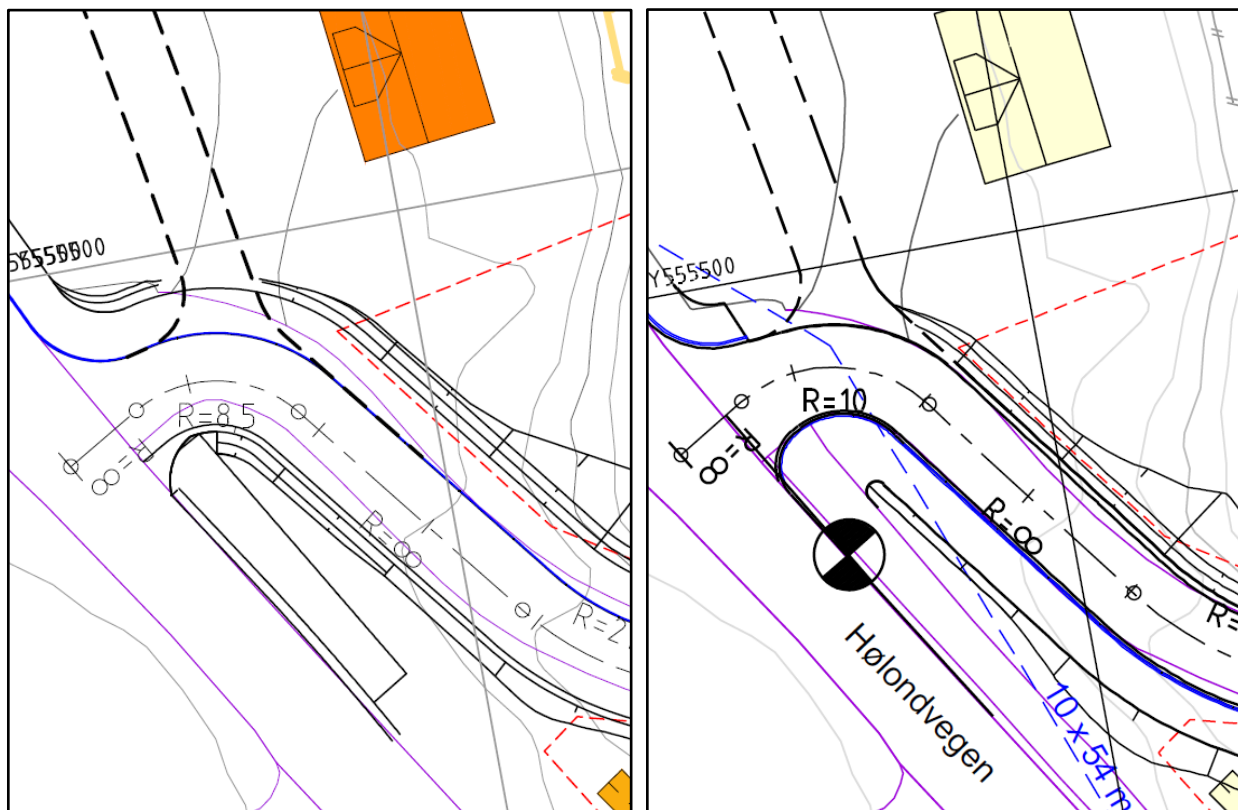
Plankart med veggeometri. Kilde: Norconsult
